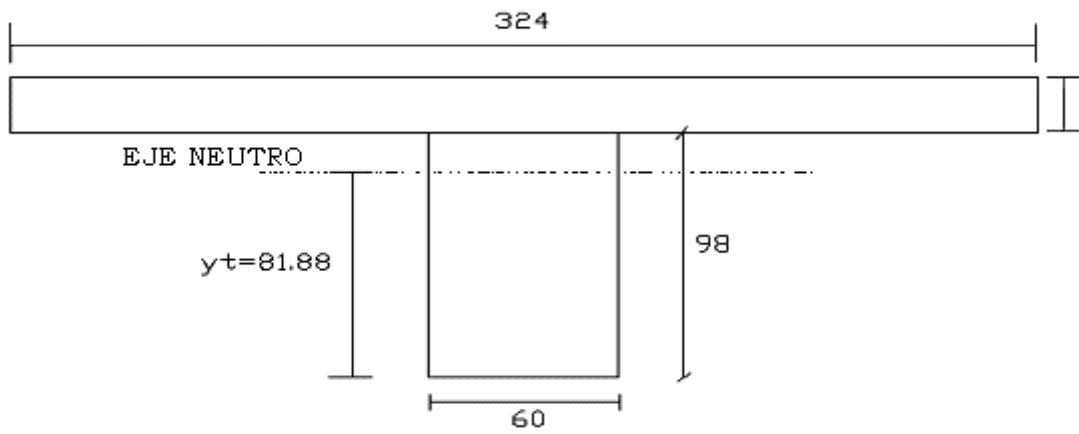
Sección no fisurada de la viga. Dimensiones en (cm).
